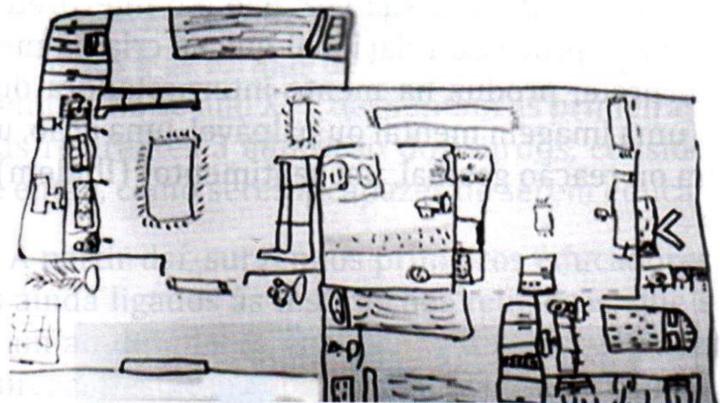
Desenho e/ou esboço planta baixa produzida por aluno - escola B9
